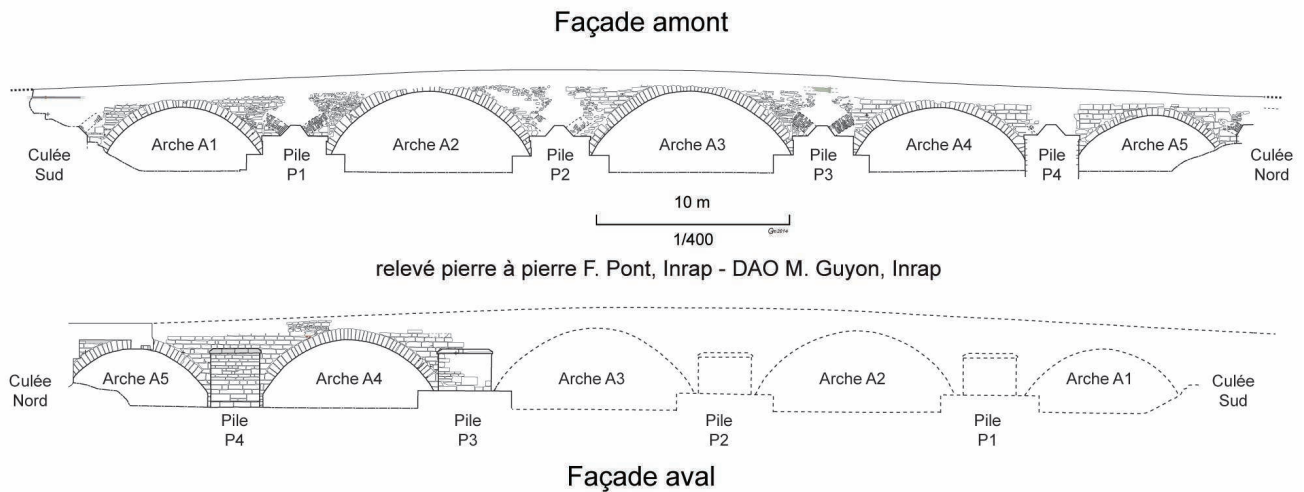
Élévation pierre à pierre de la façade amont et aval (relevé pierre à pierre F. Pont, Inrap - DAO M. Guyon, Inrap).
